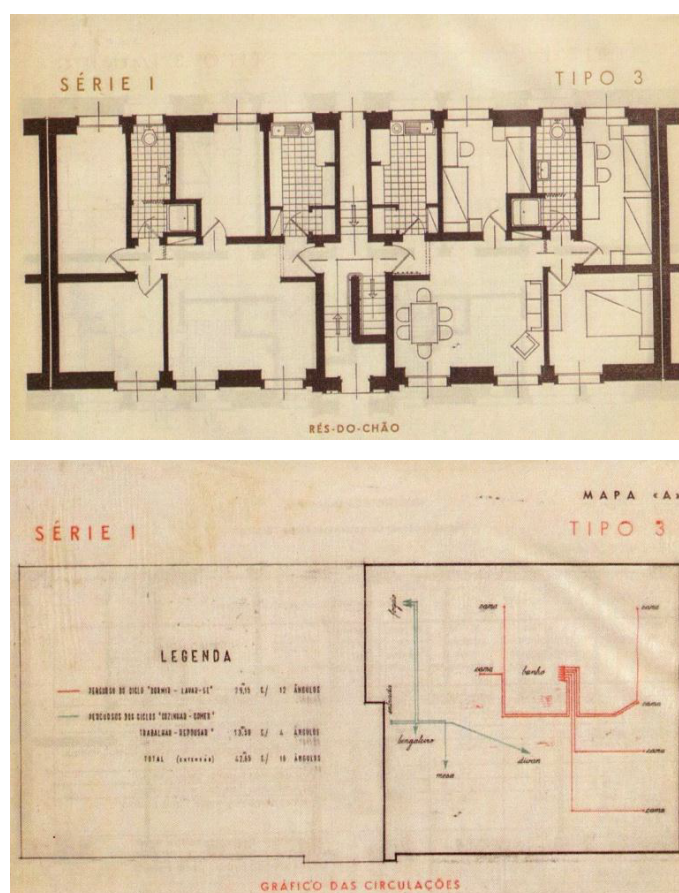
Plantas e Gráfico de Circulações publicados em Grandes Problemas de Lisboa. A construção das Casas de Renda Económica (Revista Municipal nº26 3º Trimestre, 1945).
